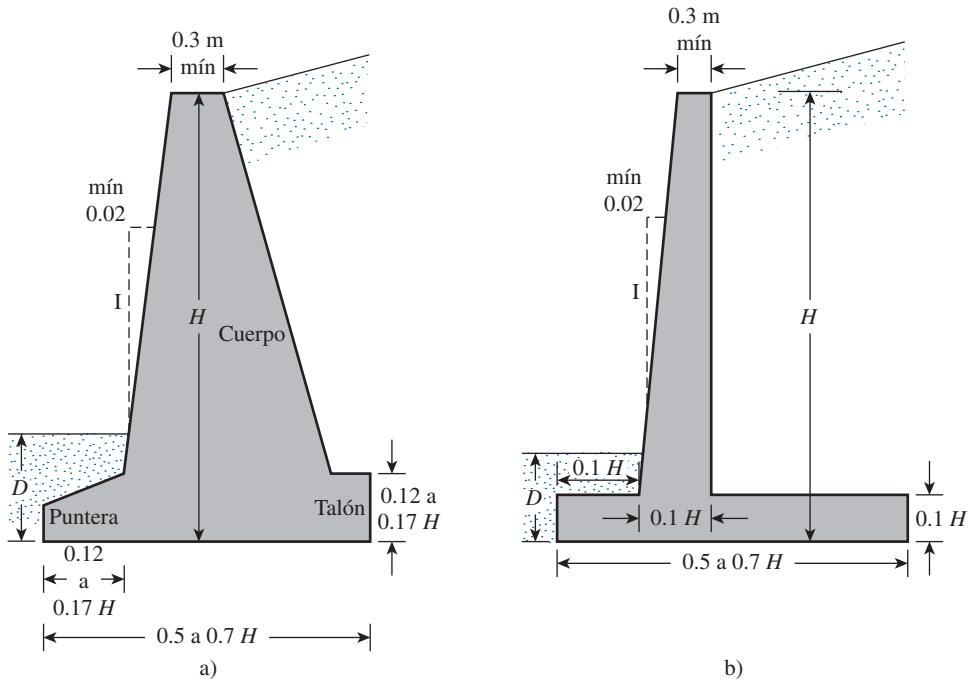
Dimensiones aproximadas para varios componentes de un muro de retención para la revisión inicial de su estabilidad: a) muro de gravedad; b) muro en voladizo.
